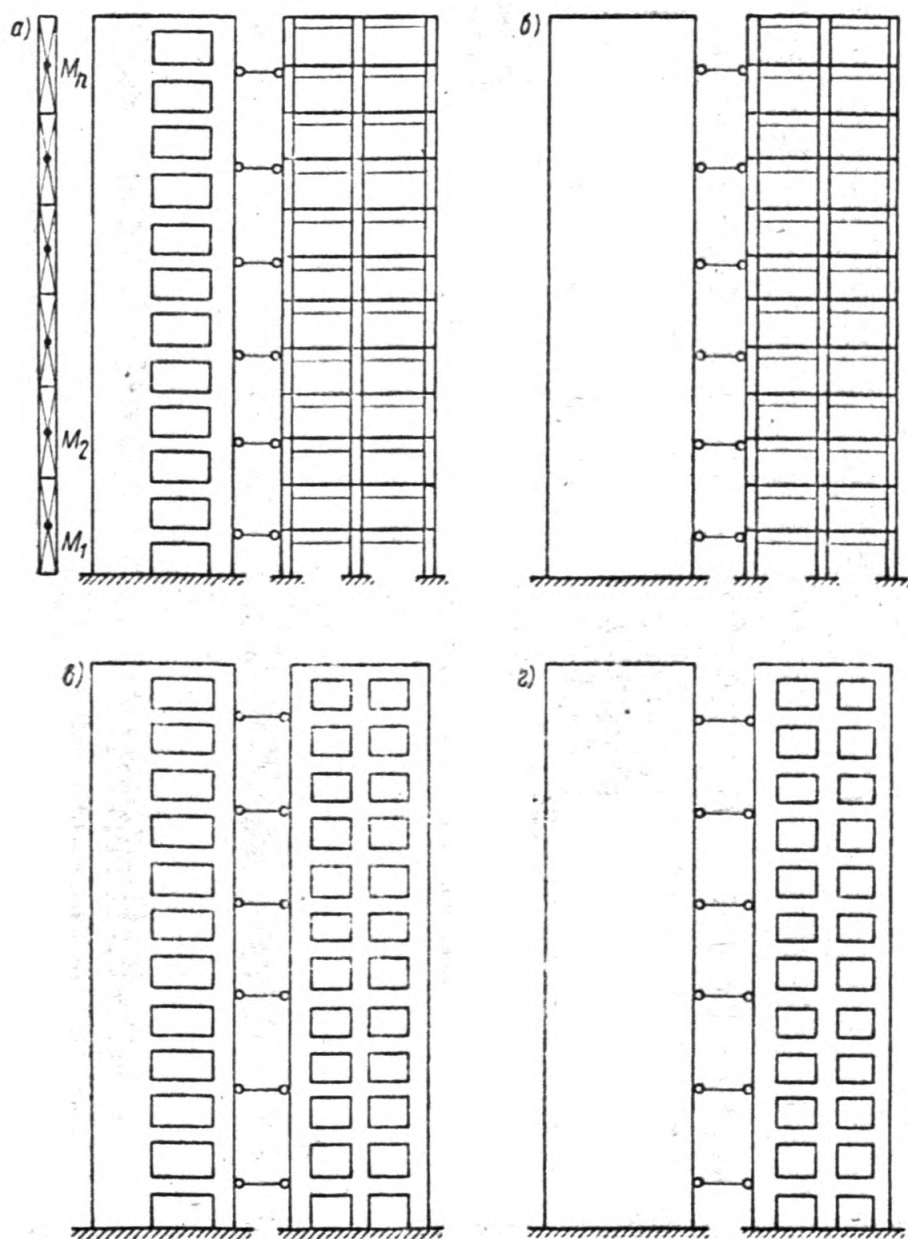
Расчетные схемы каркасных зданий сложной конструктивной схемы
